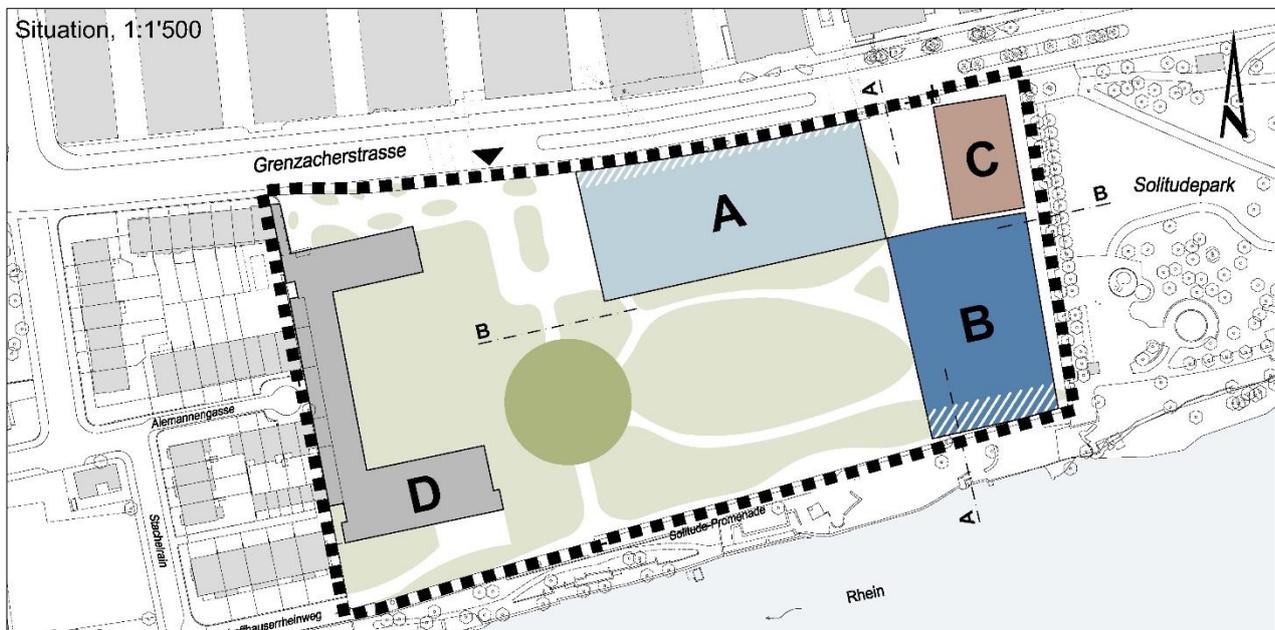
Auszug aus dem neuen Bebauungsplan. Situation (Kein Massstab, Plan genordet)
